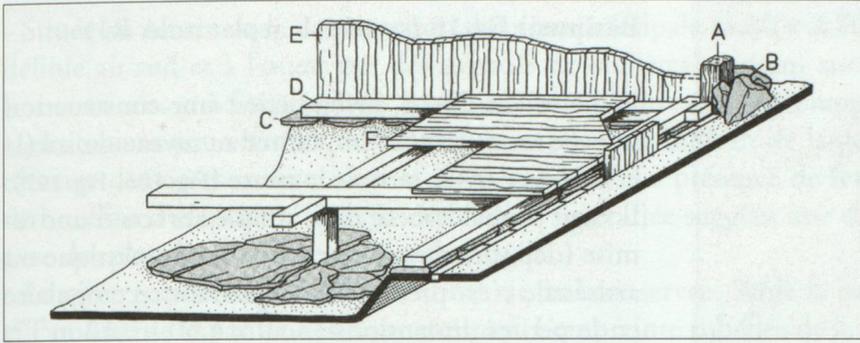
Bâtiment Bat11. Reconstitution architecturale de l'angle sud-est. A : poteau cornier, B : calage de l'angle (protection), C : solins continus, D : sablières basses, E : cloisons de planches verticales, F plancher.
